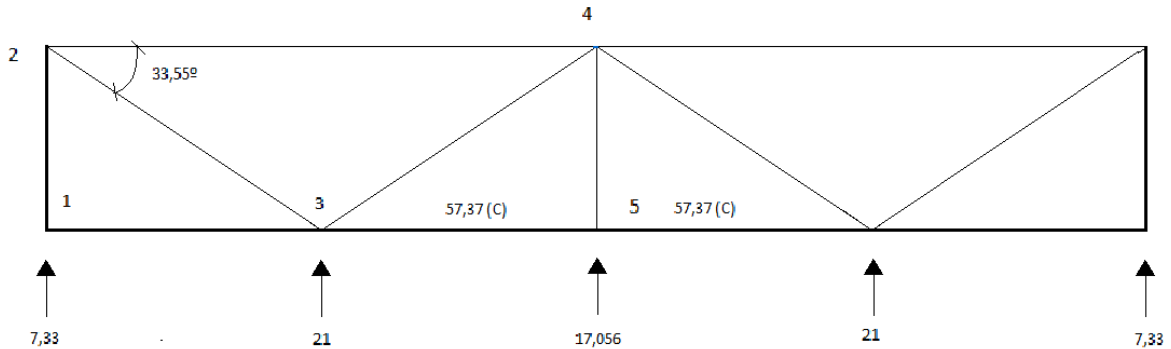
Axiles en la jácena del pórtico de fachada en VF1+VIP.
